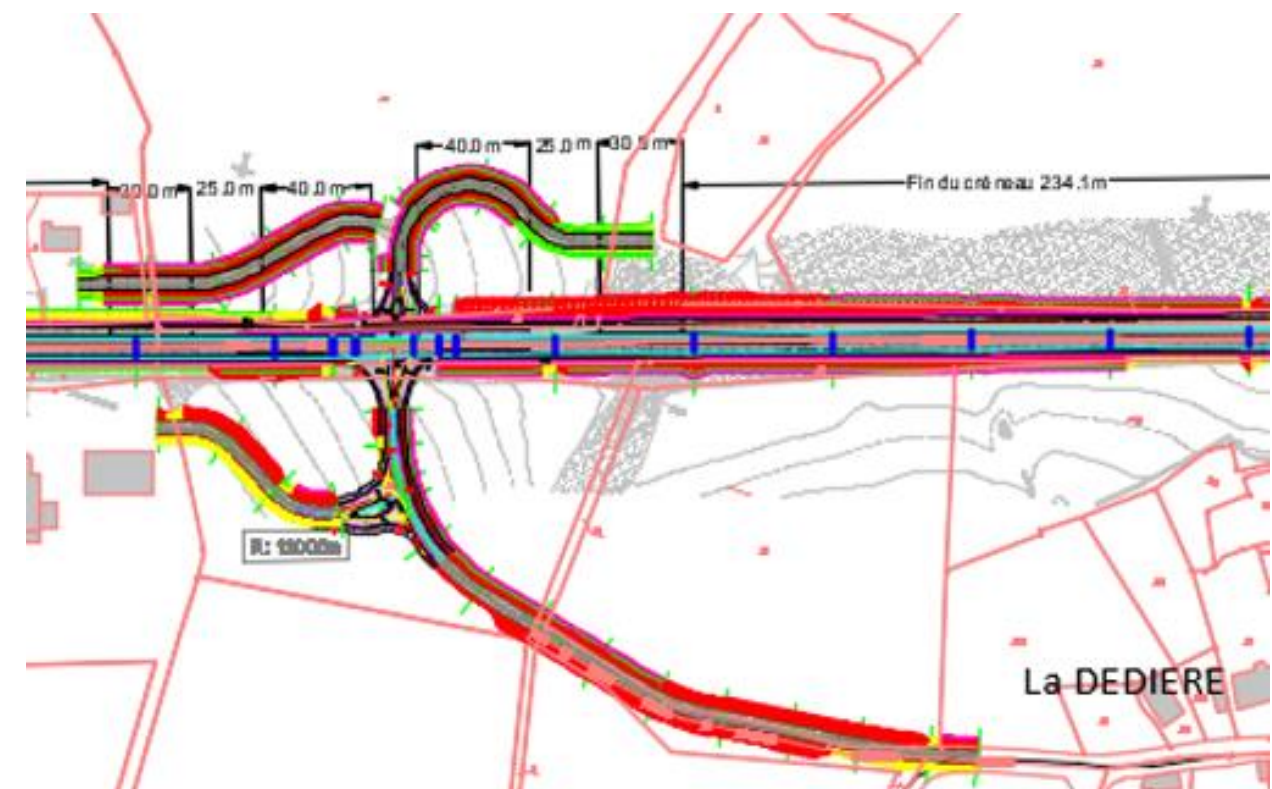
Plan du carrefour de la Dédrière - Section 1
